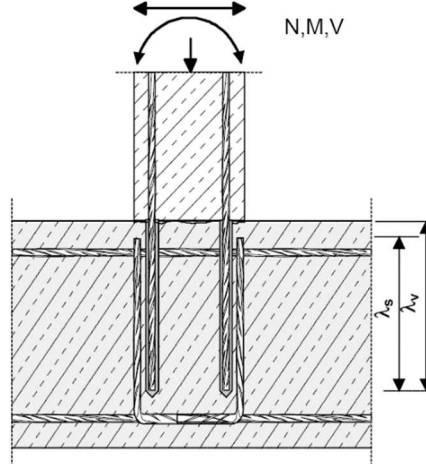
Ancrage direct d'armatures en extrémité de dalles ou poutres, simplement appuyé
